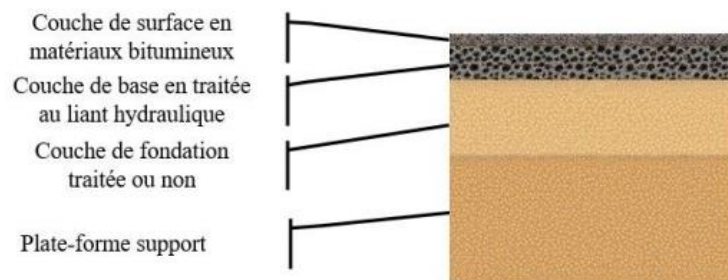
Structure d'une chaussée semi-rigide (Nguyen, 2008).
